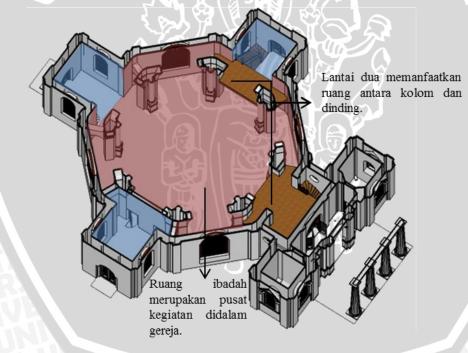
Hubungan ruang lantai 1 Gereja Blenduk
